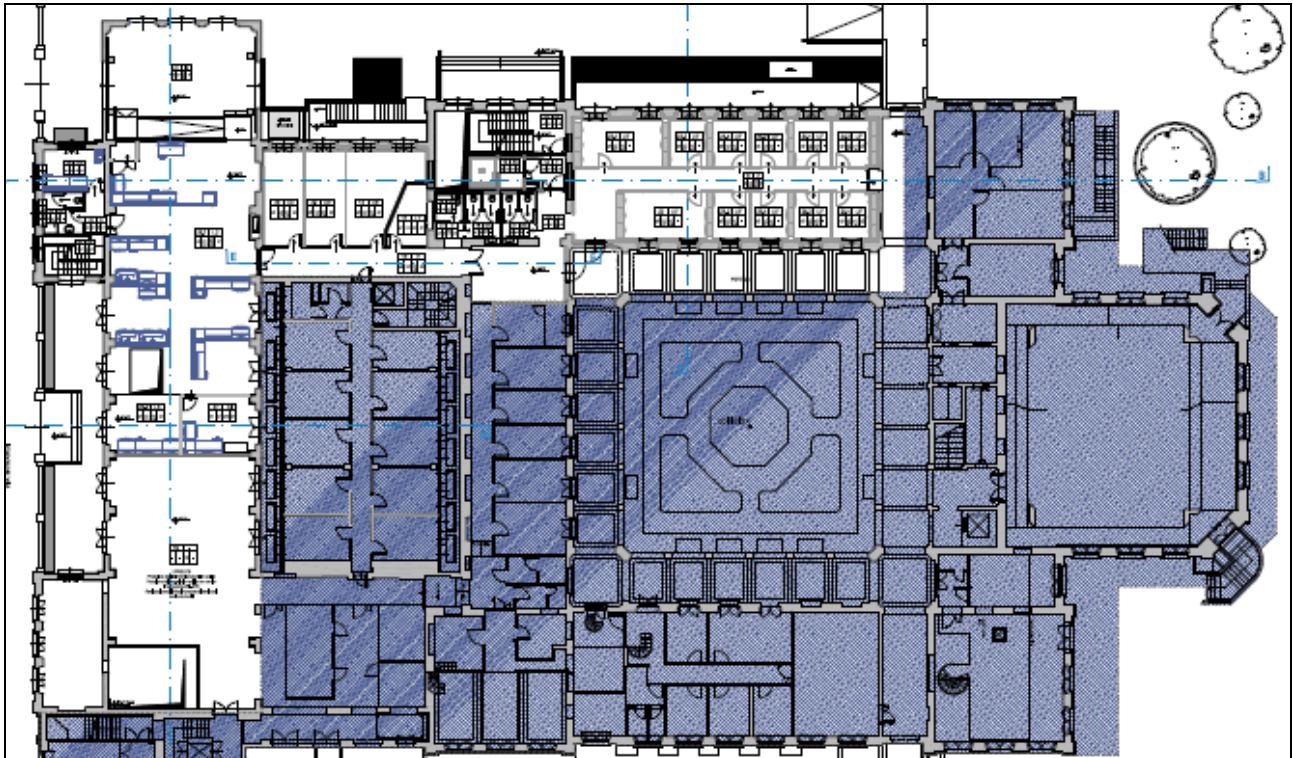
Individuazione Lotto 1 (spazi in bianco non evidenziati da campiture)
